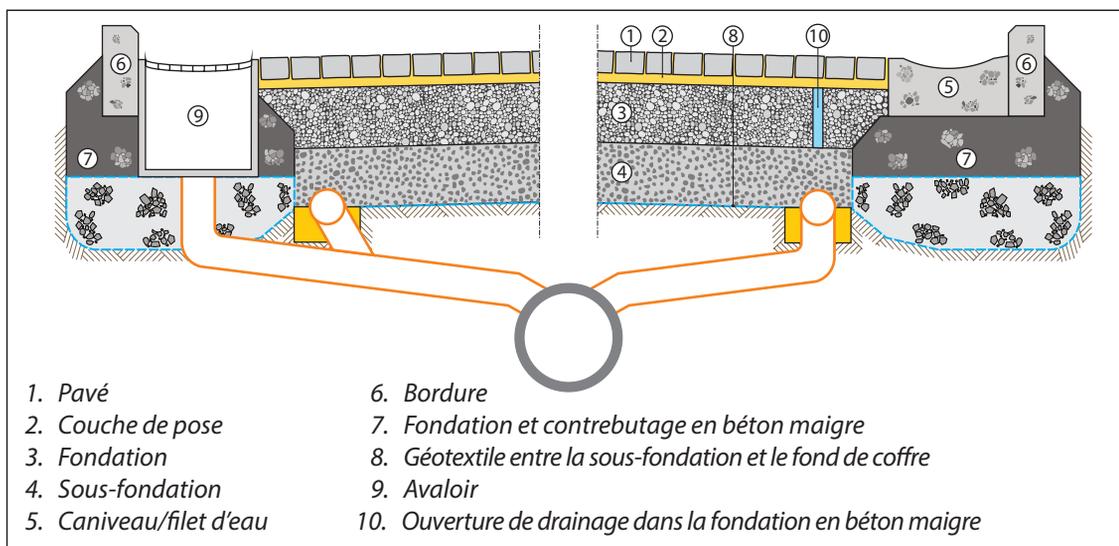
Evacuation de l'eau via l'avaloir dans le cas d'un revêtement imperméable (côté gauche) et évacuation de l'eau qui a pénétré dans la fondation via un tuyau de drainage dans le cas d'un revêtement perméable sur une fondation imperméable (côté droit)
